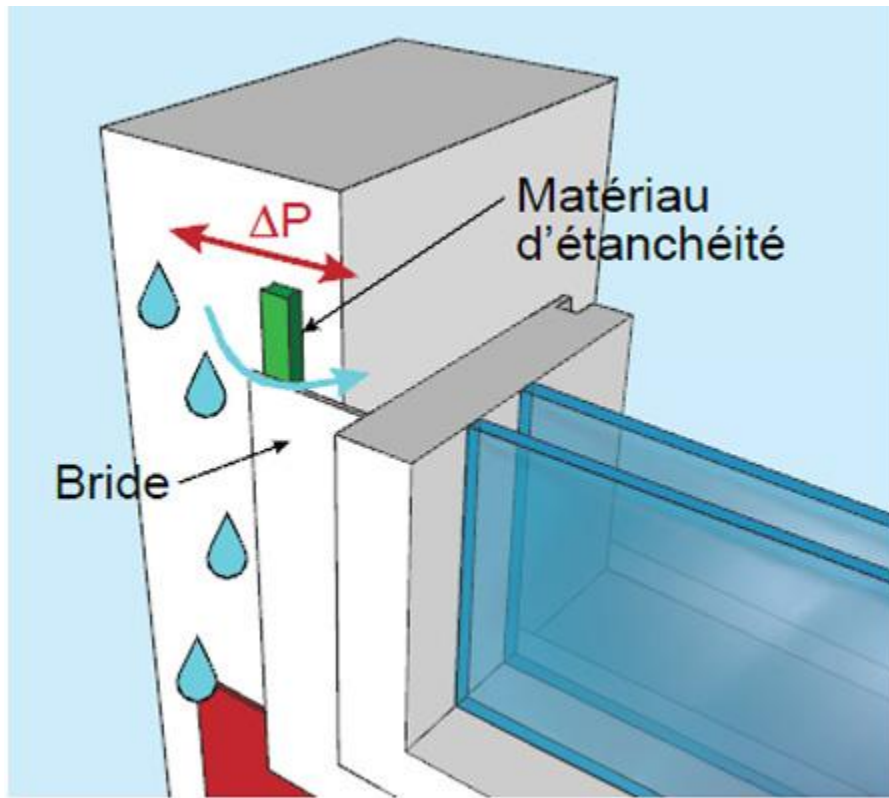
(a). Détail d'un montant de fenêtre montrant : que le matériau d'étanchéité placé à l'arrière de la bride déplace le plan d'étanchéité à l'air vers l'extérieur du mur, où l'eau pourra s'exfiltrer par les petites imperfections;
